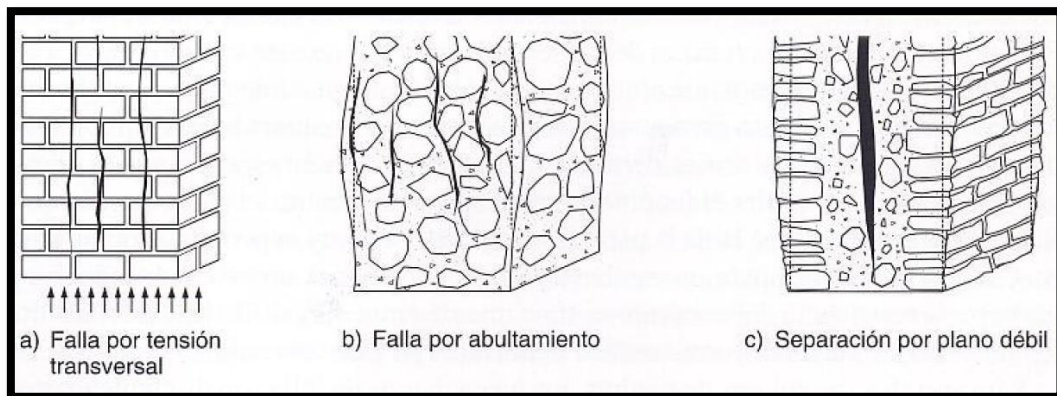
Mecanismos de falla de la mampostería (Meli, 1998)
